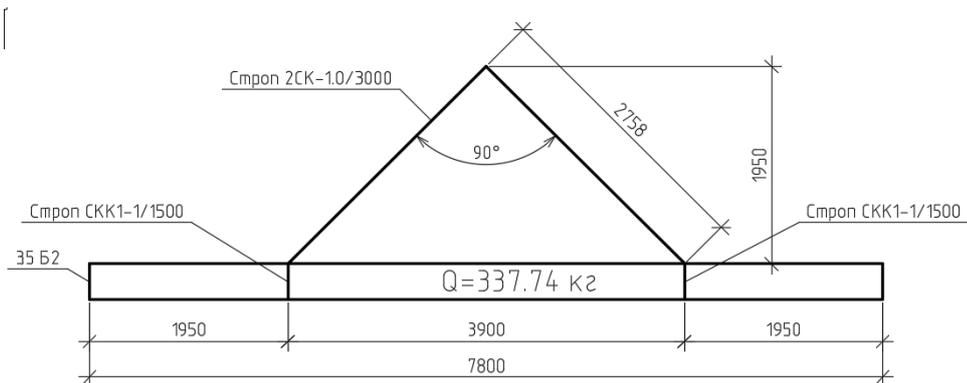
Определение длины стропов для монтажа балки покрытия
